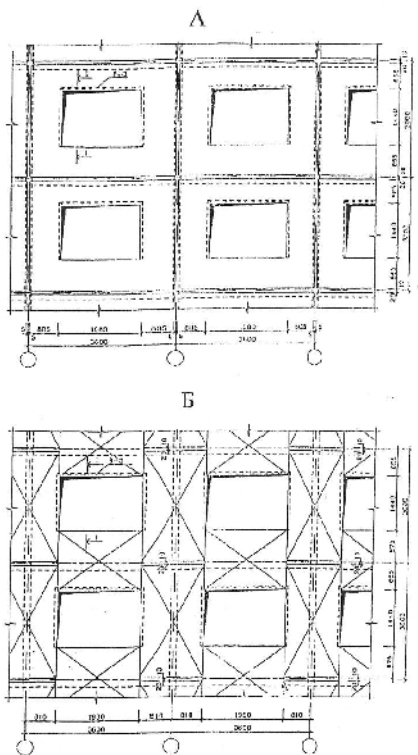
Схемы раскладки сборных железобетонных облицовочных скрупок на фасаде: А – при "бубличной" раскладке скрупок; Б – при вертикальной полосовой раскладке
